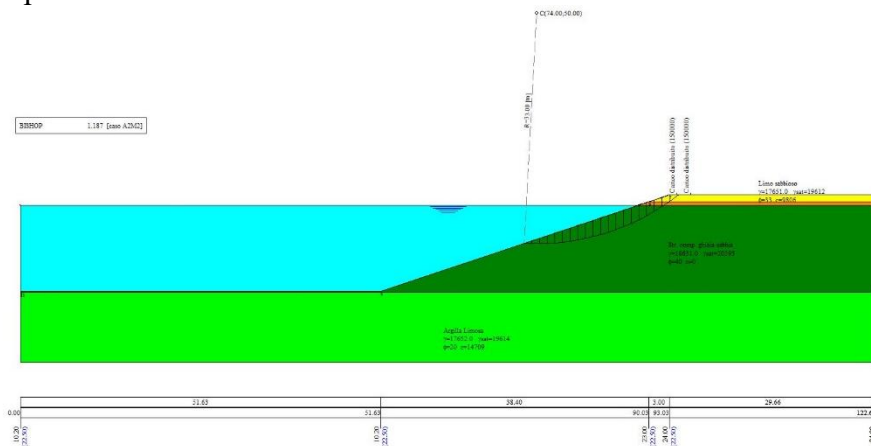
CALCOLO STABILITÀ SPONDE DI SISTEMAZIONE
